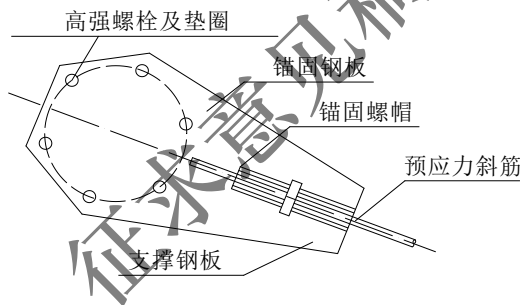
黏结-摩擦锚固的构造示意图
